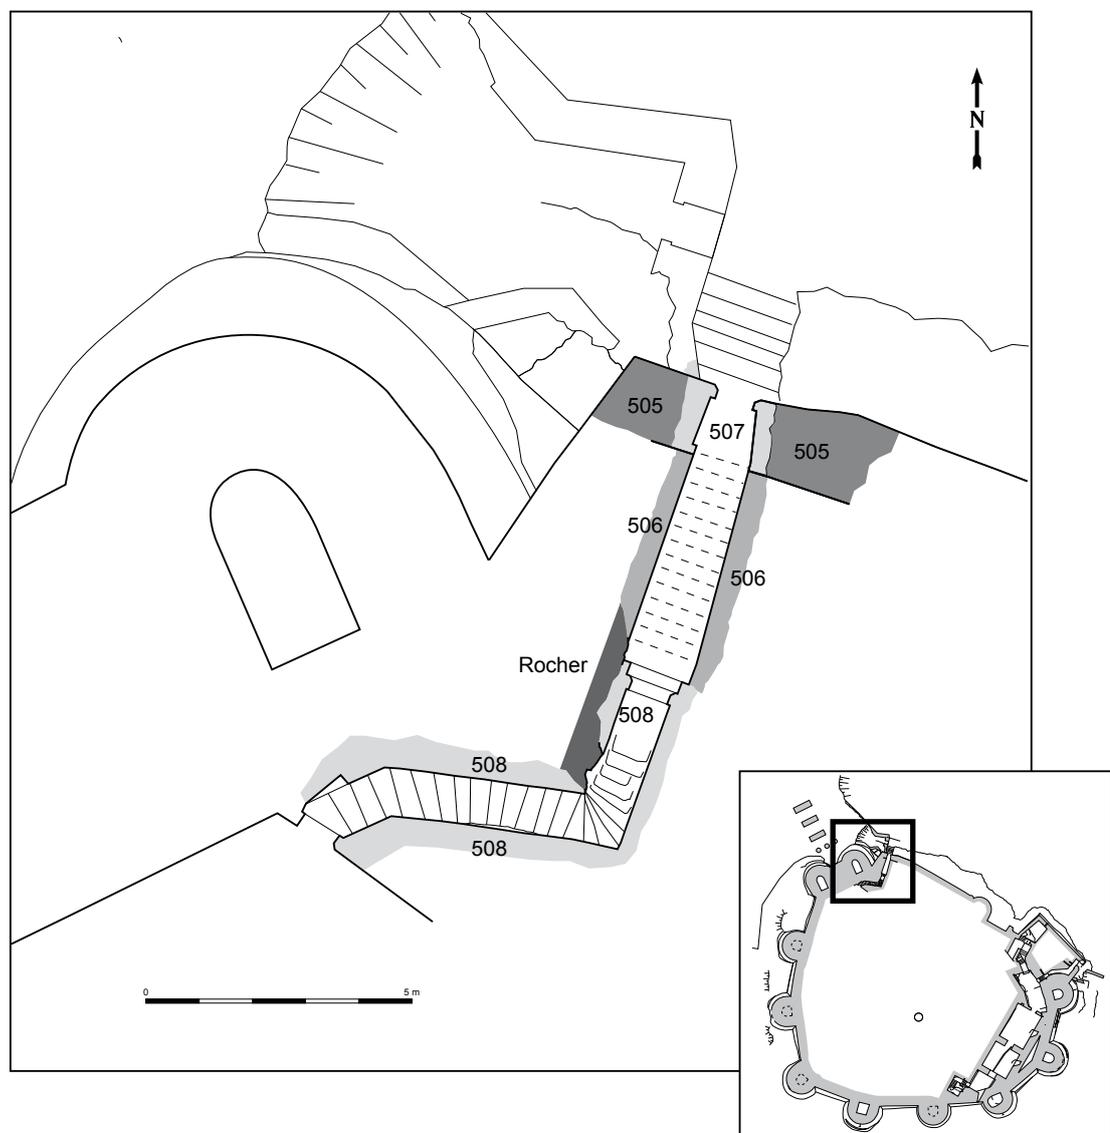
Plan et proposition de phasage du couloir avec les deux poternes situées au pied de la tour 1 (SADML).
